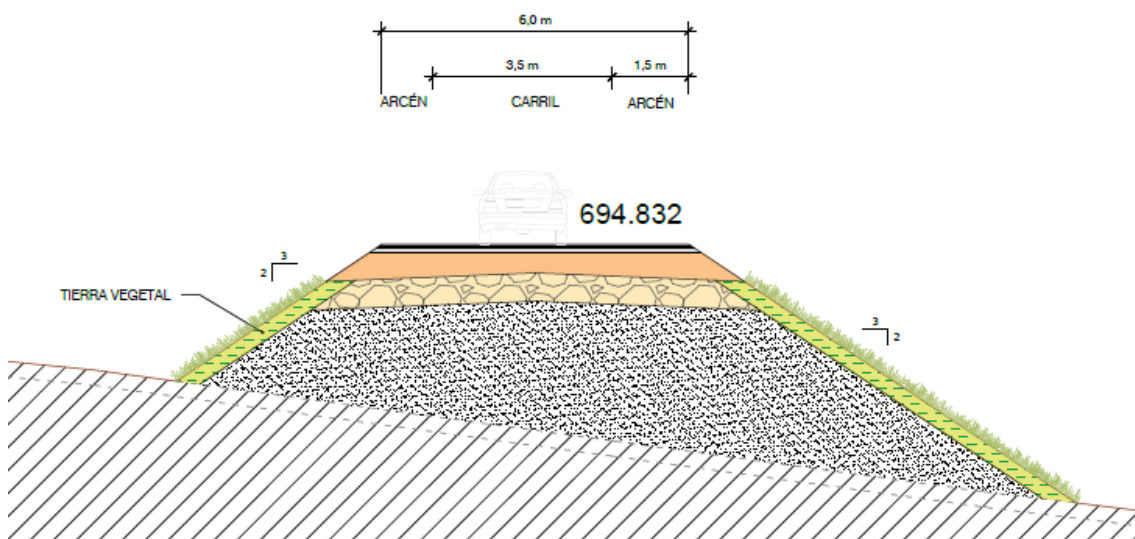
Sección tipo de ramal en terraplén. (Fuente: Elaboración propia.)
